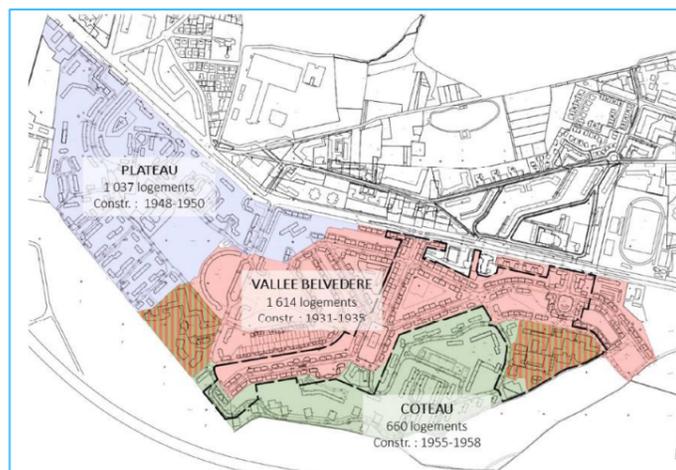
Plan masse de la Cité Jardin actuelle (Source : Hauts-de-Bievre Habitat)
